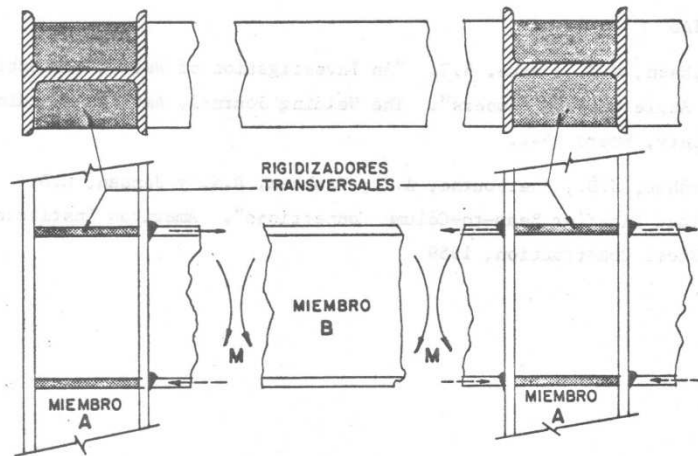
DISPOSICION TIPICA DE RIGIDIZADORES TRANSVERSALES
